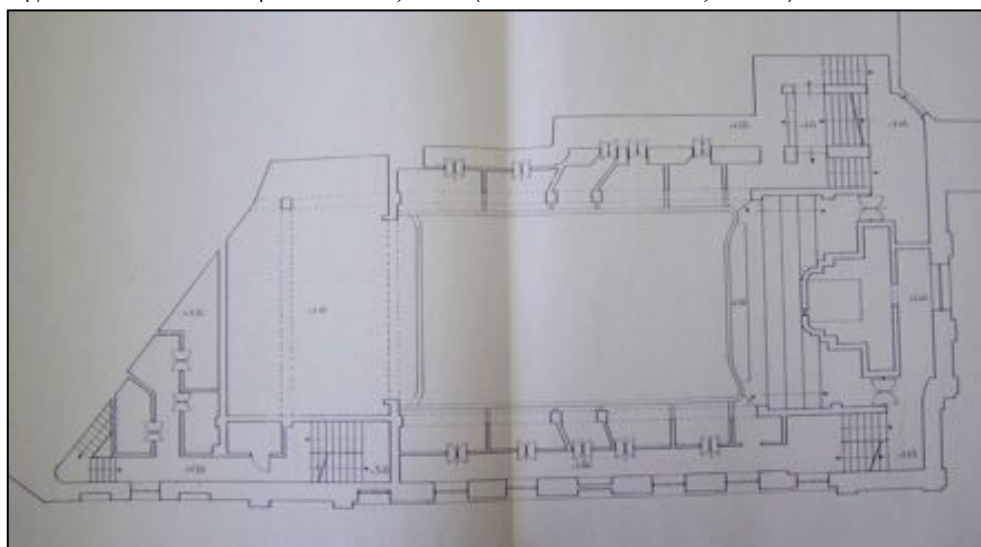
Planimetria del primo livello di palchi, 1994 (ASBAPSAE Ce-Bn, f.1040).
